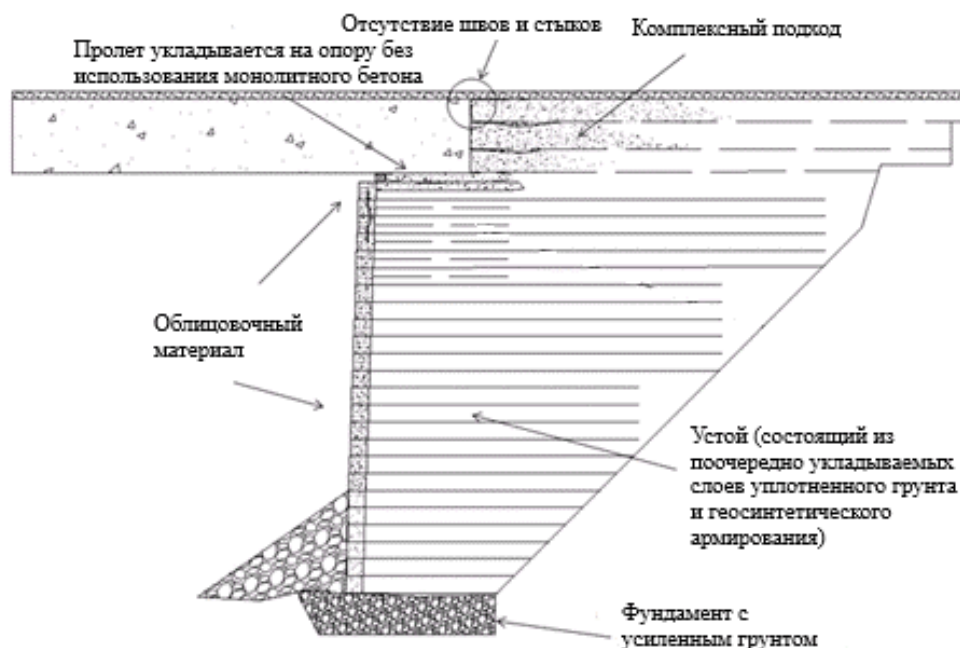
Общий вид береговой опоры с использованием армированного грунта
